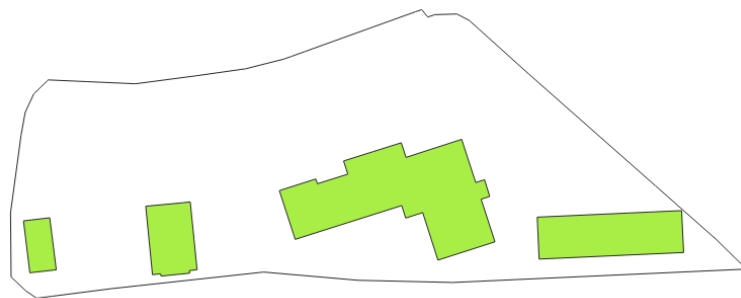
Grundrissanalyse zur Erreichung der GFZo 0.5 bei 2-geschossiger Bauweise ohne Dachausbau/Attika.
